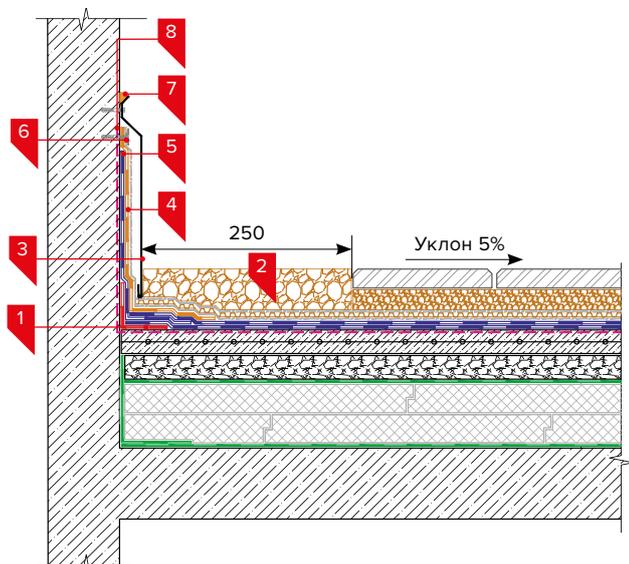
Крепление кровельного ковра на вертикальных поверхностях железобетонных стен
